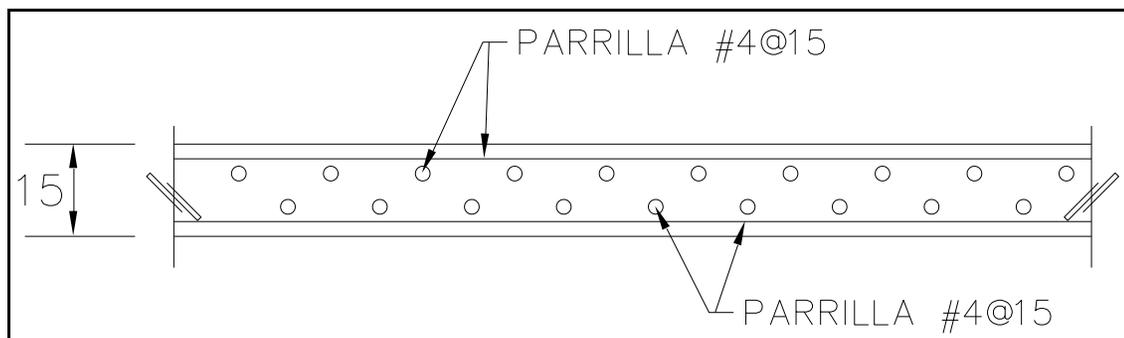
Detalle 1, losa superior de zapata A10 – A11.
